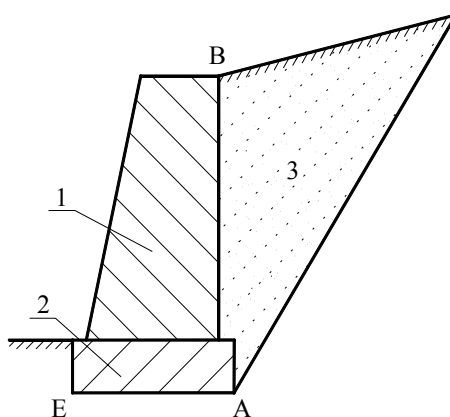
Элементы подпорной стены: 1 – тело; 2 – фундамент; 3 – засыпка
